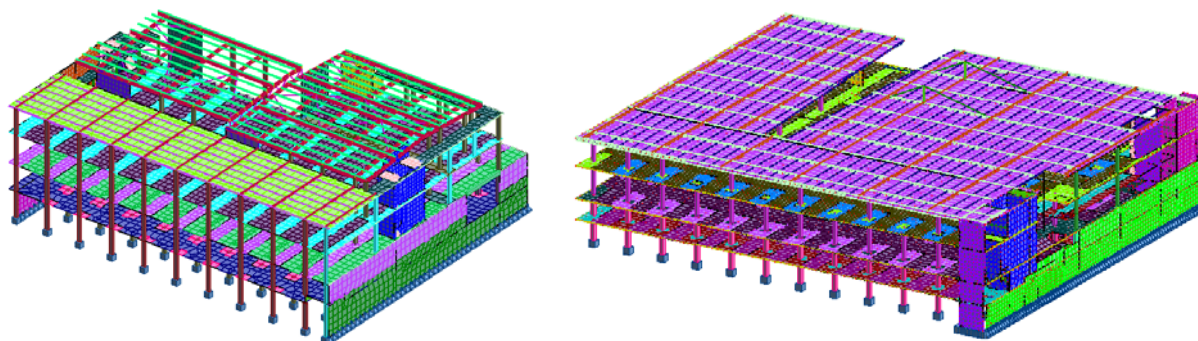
Modelos de cálculo de 2 corpos estruturais.
